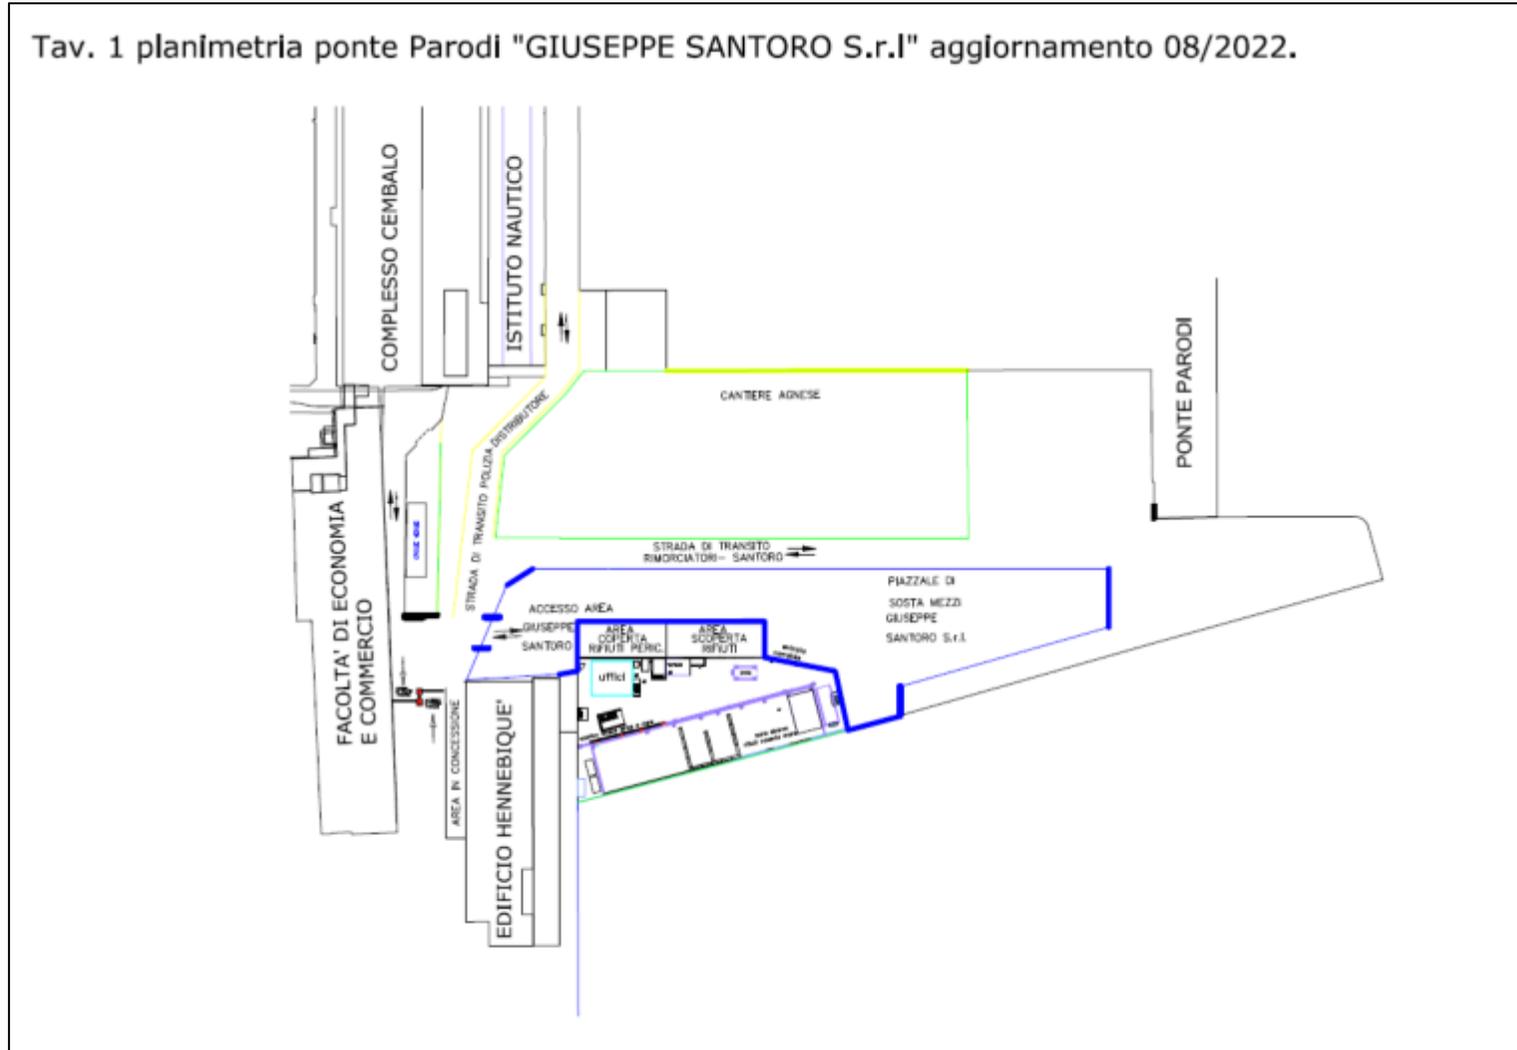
Planimetria impianto Giuseppe Santoro S.r.l.
